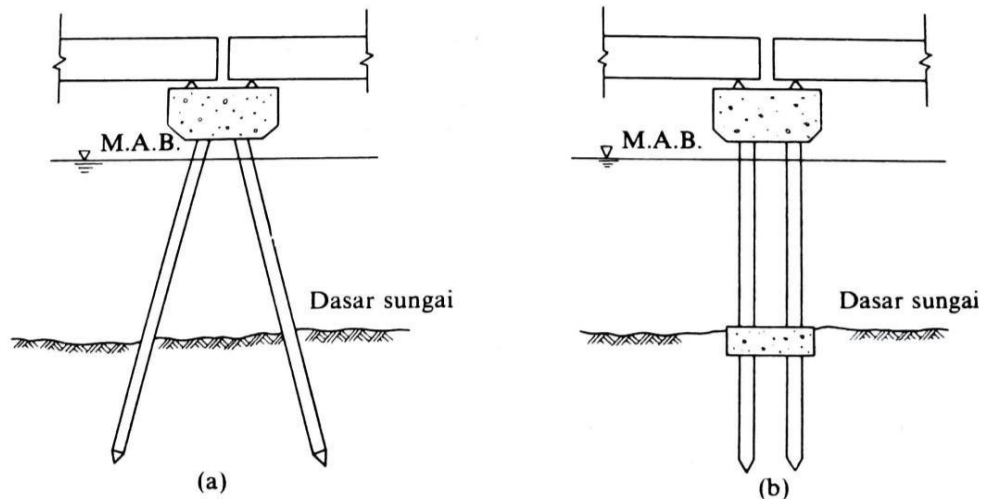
6 Bentuk umum pilar jembatan yang dibangun di sungai
